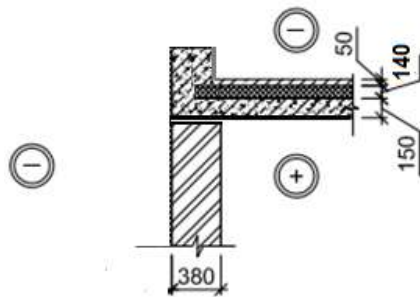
Существующее конструктивное узла примыкания наружной стены к чердачному перекрытию.
